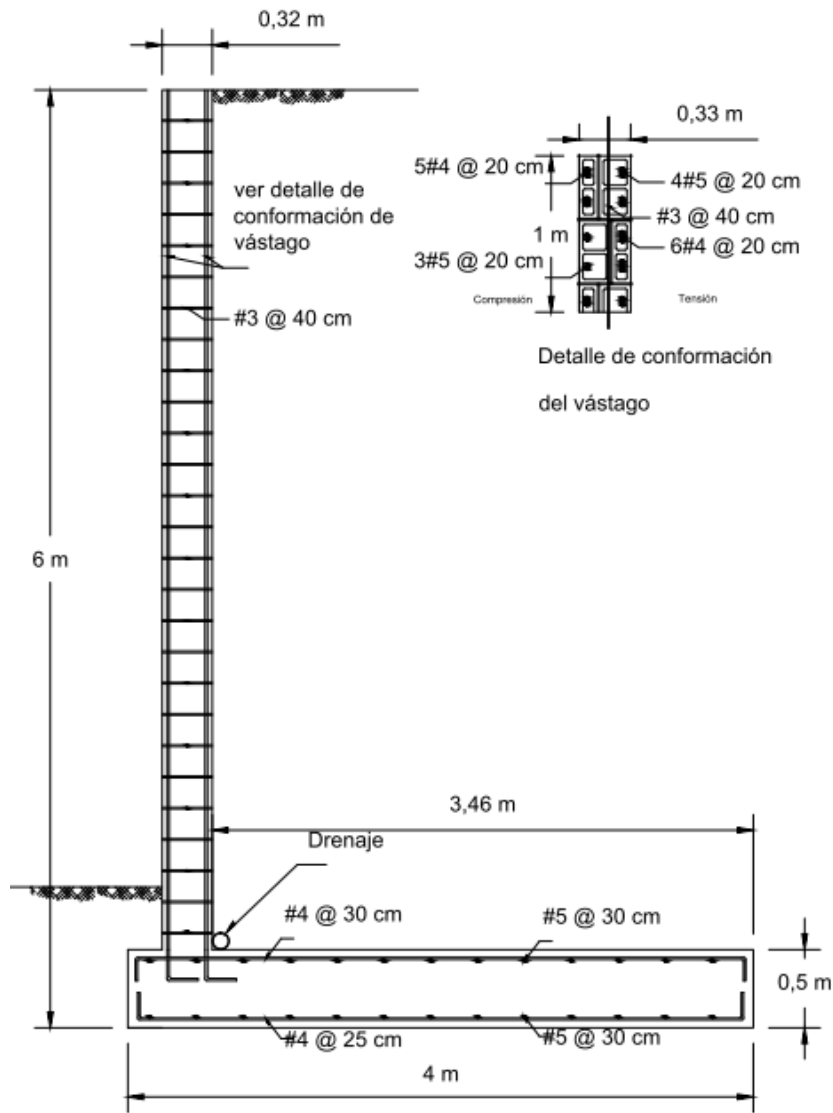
Muro de mampostería de 6m de altura con un suelo S3
